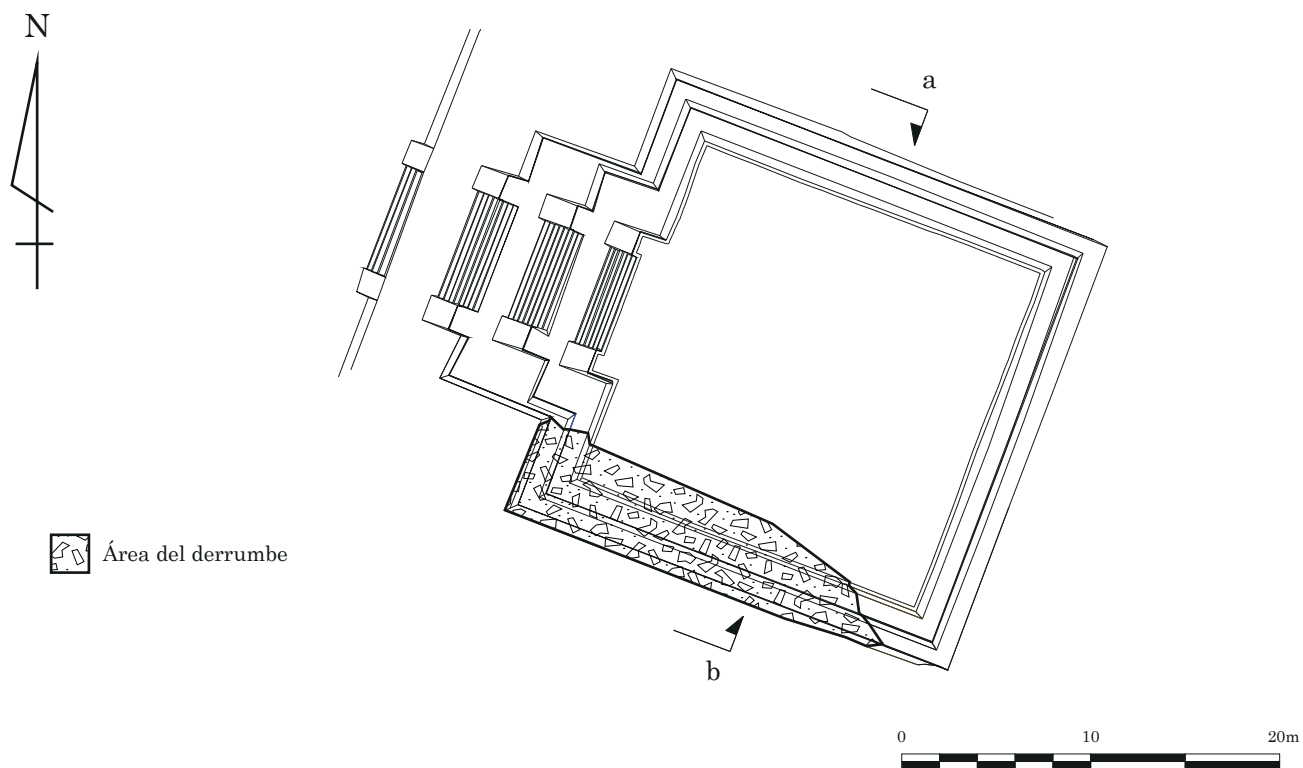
Plano de la Estructura B1-2 y el área del derrumbe ocurrido el 18 de octubre, 2004
